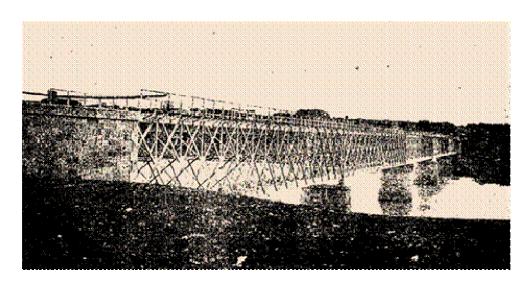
Puente sobre el Duero – Revista de Obras Pública, 1896
